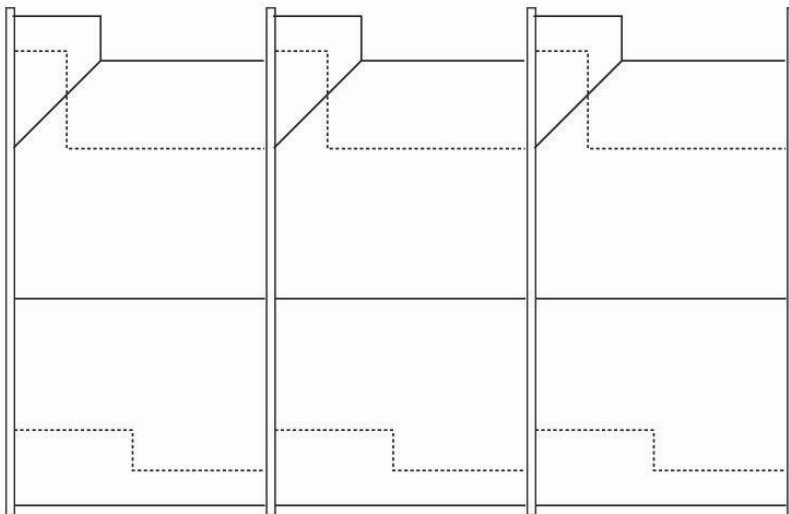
Planta de cobertura das três unidades em desnível. Fonte: Construpex (2009)
